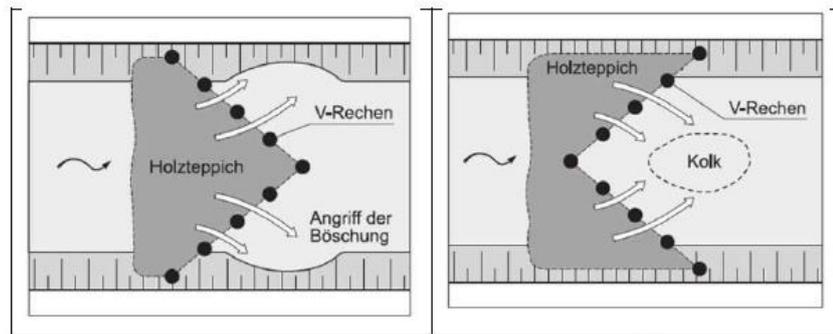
Schematische Darstellung (Lange & Bezzola 2006) von V-Rechen zur Rückhaltung von Treibgut: links Öffnung bachaufwärts, rechts Öffnung bachabwärts
